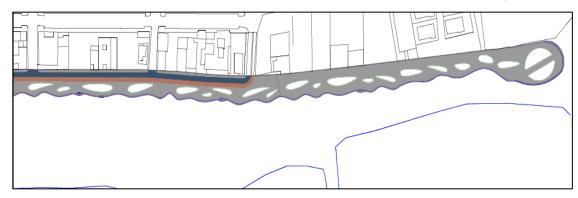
Detalle zona norte del paseo marítimo. Fuente: Propia
